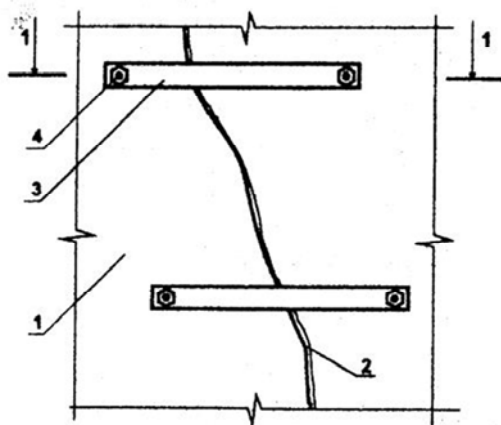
Усиление участков кладки двусторонними металлическими накладками на болтах:
